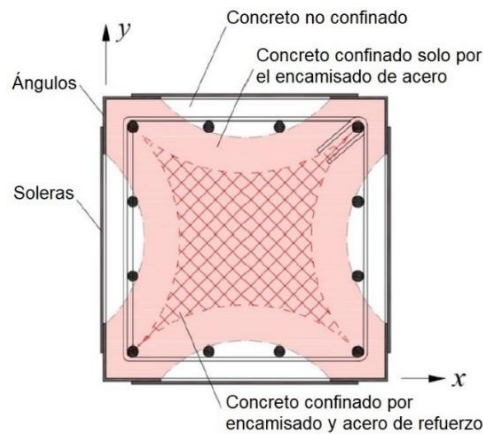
Zonas efectivamente confinadas por estribos y camisas de acero, adaptado de Di Trapani et al. (2020).
